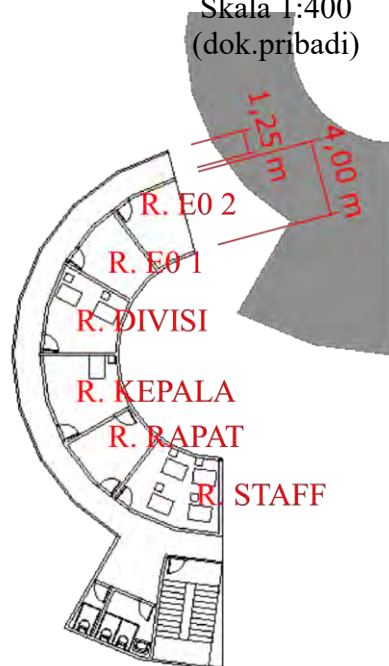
Denah Lantai 1 Bangunan Utama
